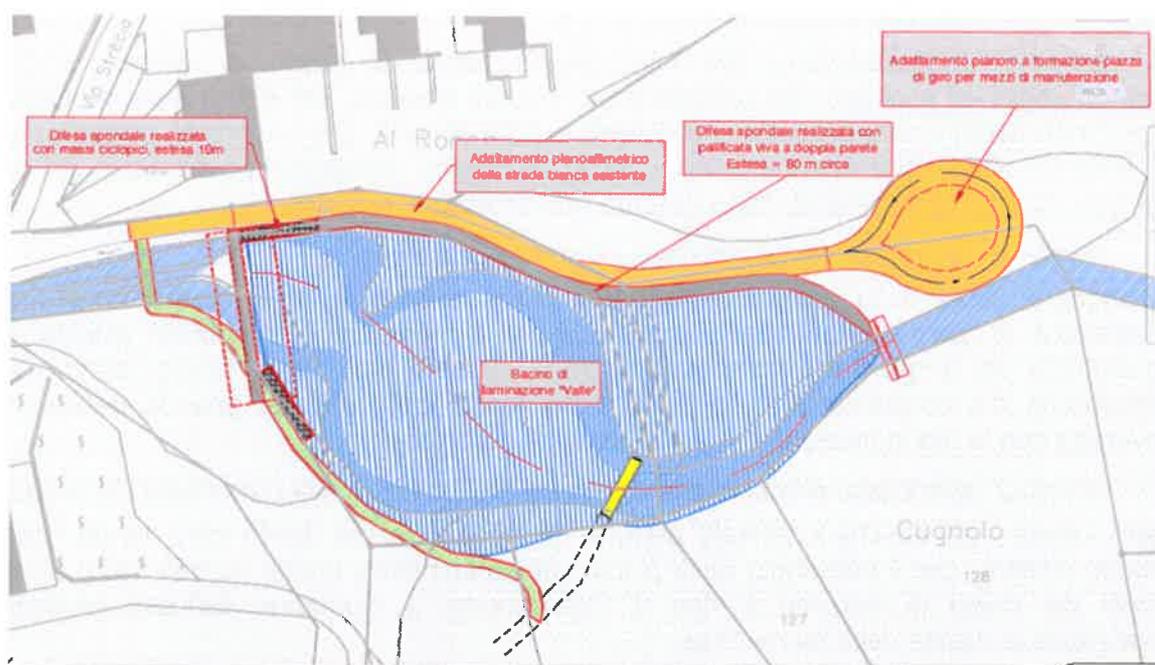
Estratto planimetrico del tracciato della nuova pista di manutenzione (in giallo)
